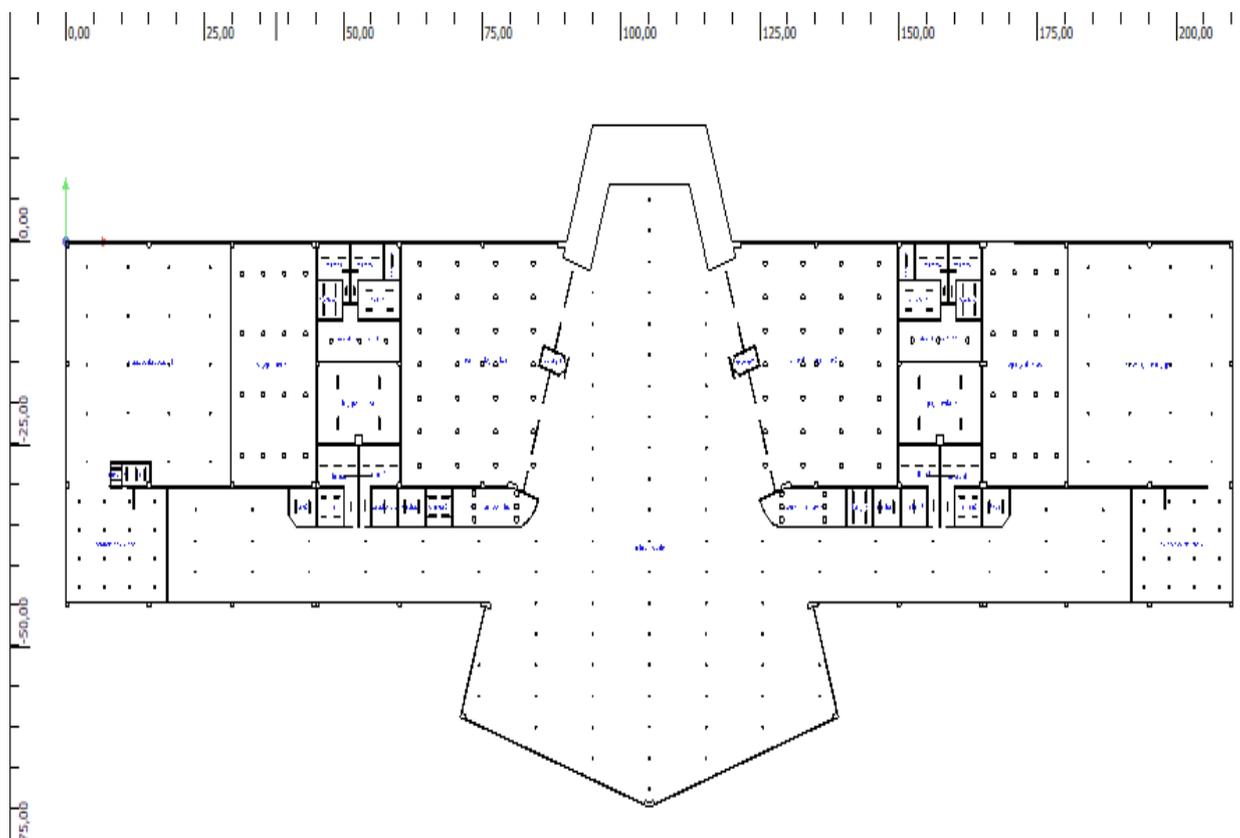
dispositions des luminaires dans le rez-de-chaussée
